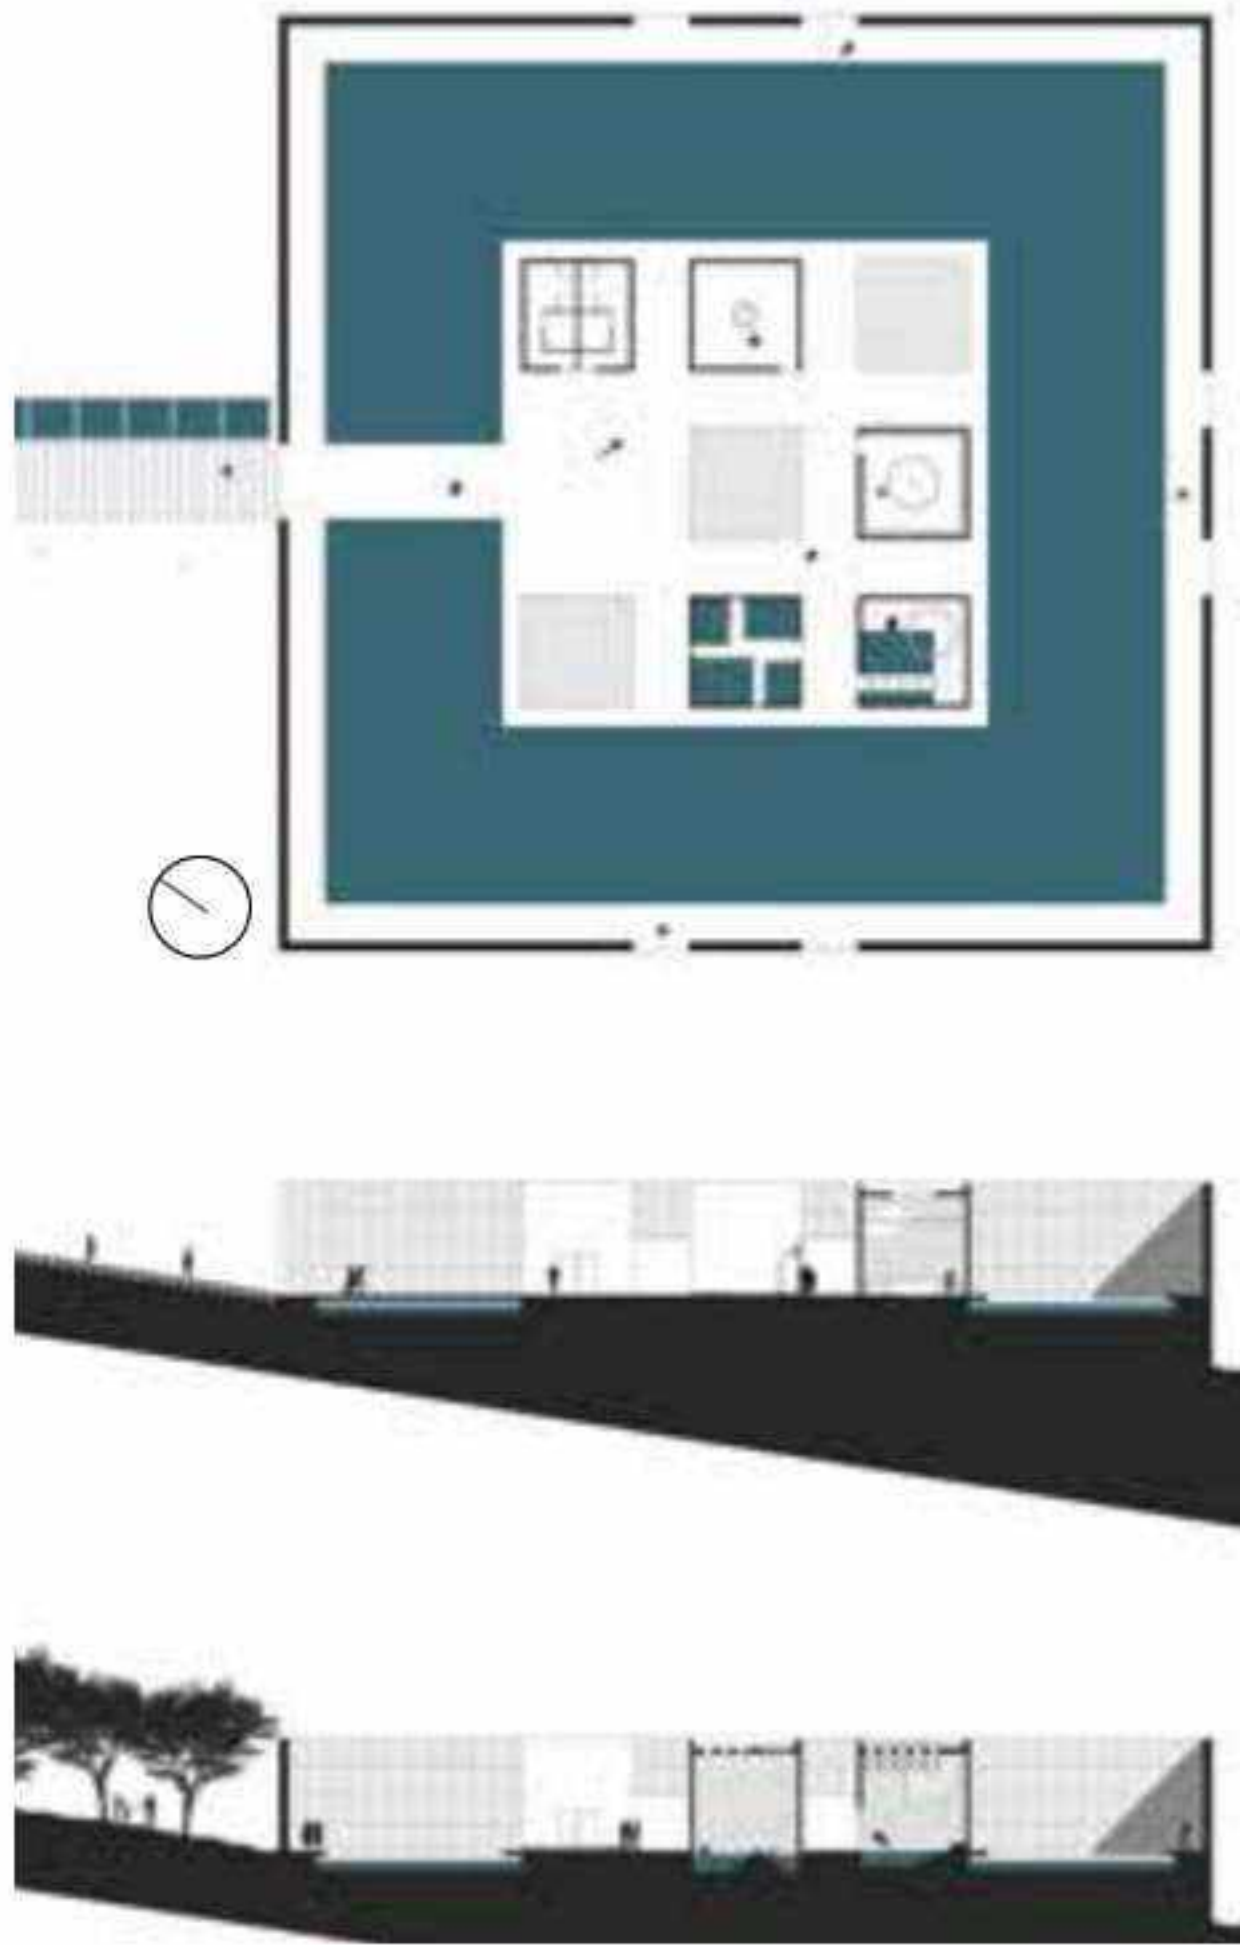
Pianta e sezioni del nuovo edificio termale.
